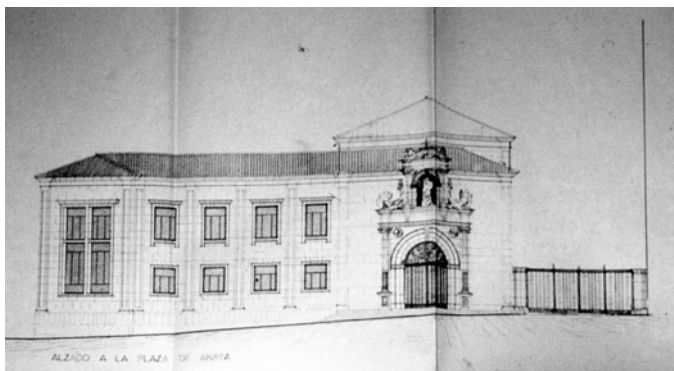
C. M. Santa María de los Ángeles: fachada a la plaza de Anaya, por Fernando Población, mayo de 1962.
